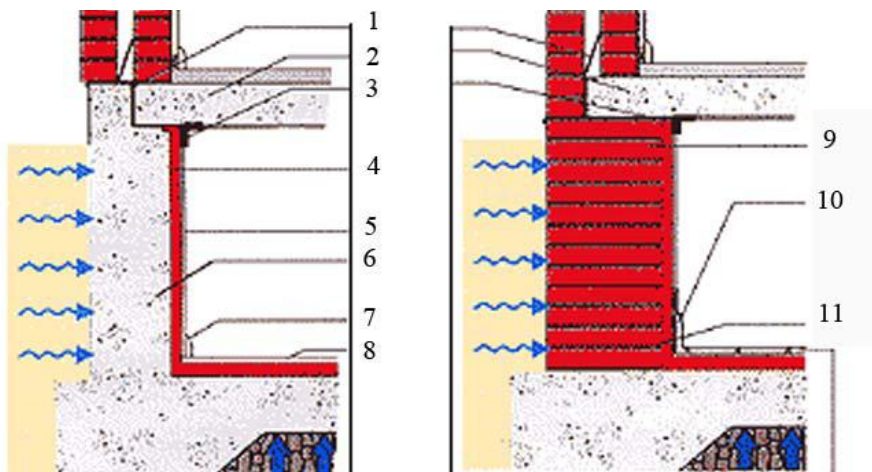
Примеры гидроизоляции подвалов материалами фирмы Sika: 1 – горизонтальная гидроизоляция; 2 – бетонный пол; 3- Sikadur Combiflex; 4 – штукатурная гидроизоляция на основе Sika-1; 5 – отделочная штукатурка (при необходимости); 6 – стена фундамента; 7 – деревянный плинтус, приклеенный Sikaflex 11 FC; 8 - декоративное покрытие на цементно-песчаной стяжке толщиной 40 мм, изготовленной с использованием Sika-1; 9 – кирпичная стена; 10 – керамическая плитка, уложенная на Sikadur 31; 11 – шов кирпичной кладки, расширенный на глубину 12 мм и заполненный раствором на базе Sika-1
